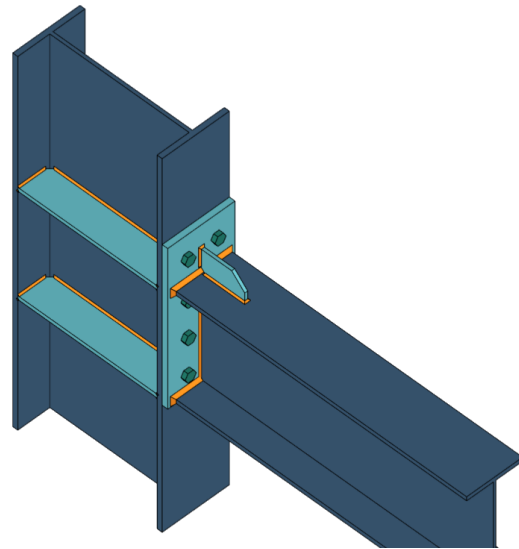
Encastrement poteau-poutre intermédiaire avec platine débordante et raidisseur sur semelle
